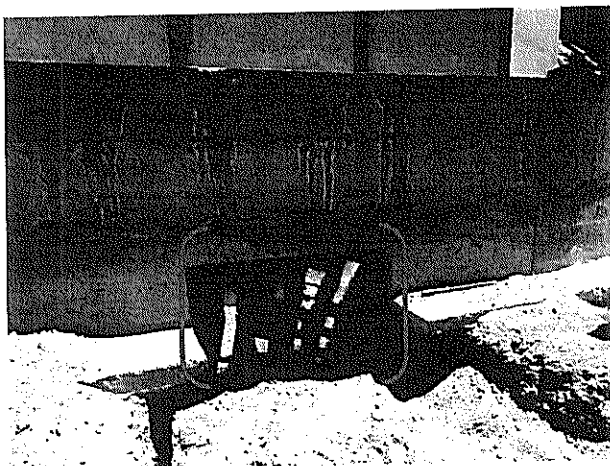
, muros prefabricados de hormigón desaplomados eje Ha del edificio A, 17-11-2015.
